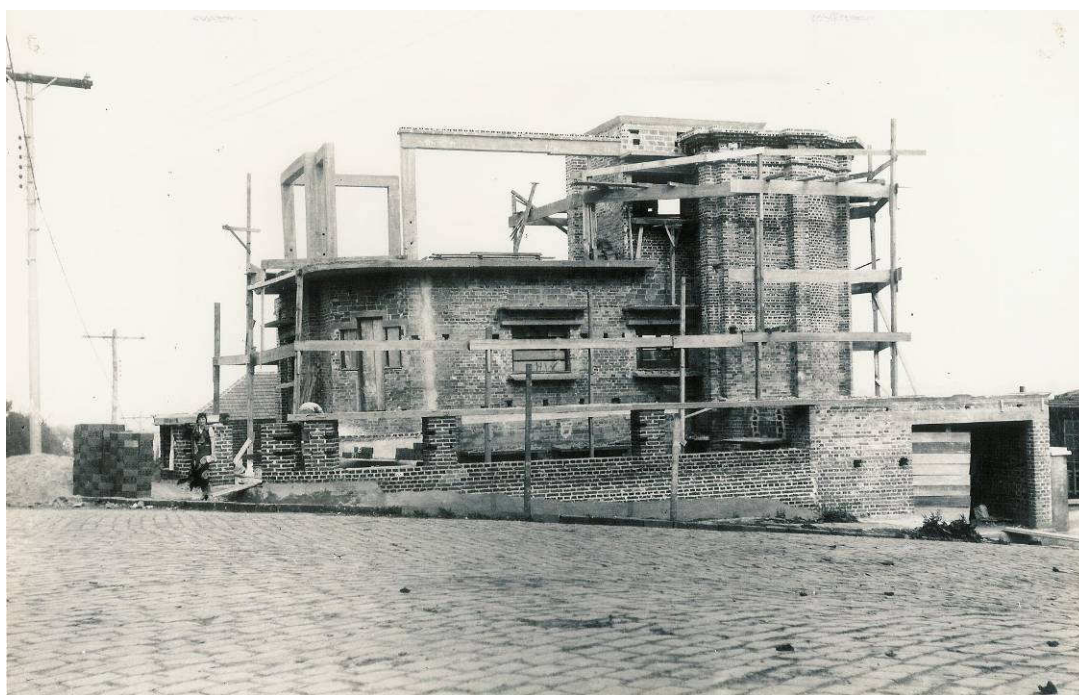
CONSTRUÇÃO DA RESIDÊNCIA
